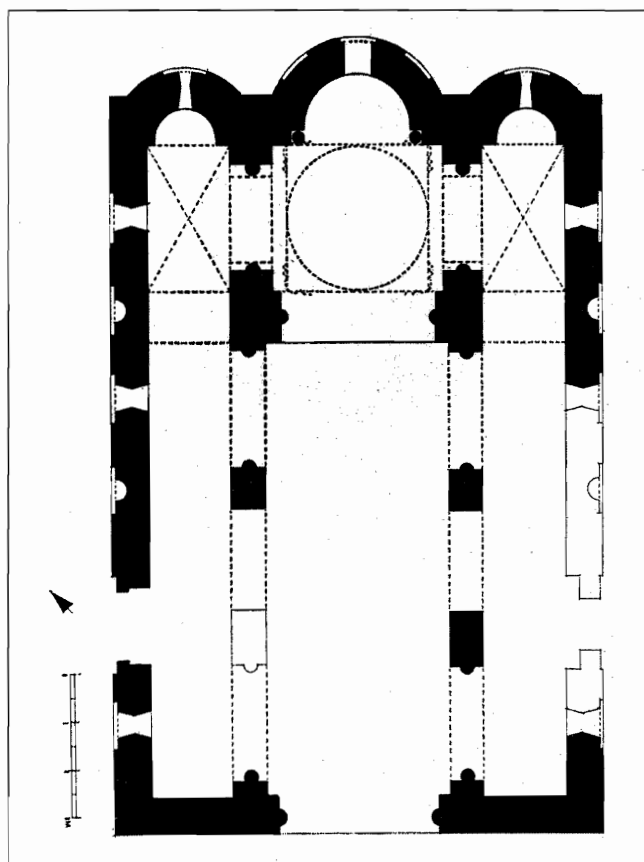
Staiti. Santa Maria de Tridetti. Planimetria chiesa (Basile 1975)
